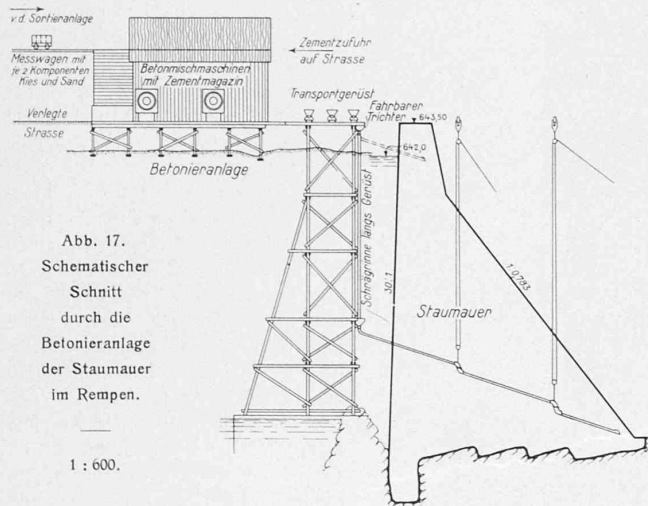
Schematischer Schnitt durch die Betonieranlage der Staumauer im Rempen.
